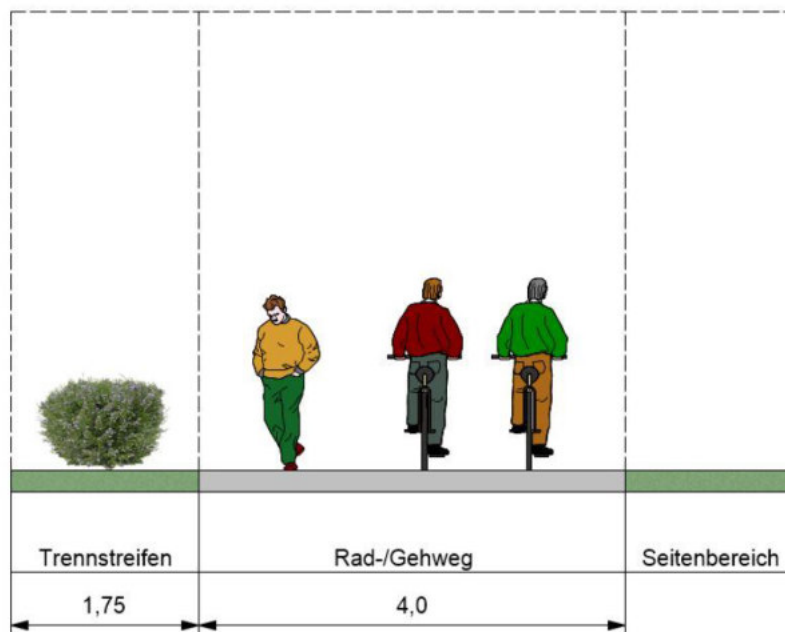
Querschnitt einer Haupttroute außerhalb bebauter Gebiete bei Anwendung eines reduzierten Standards
